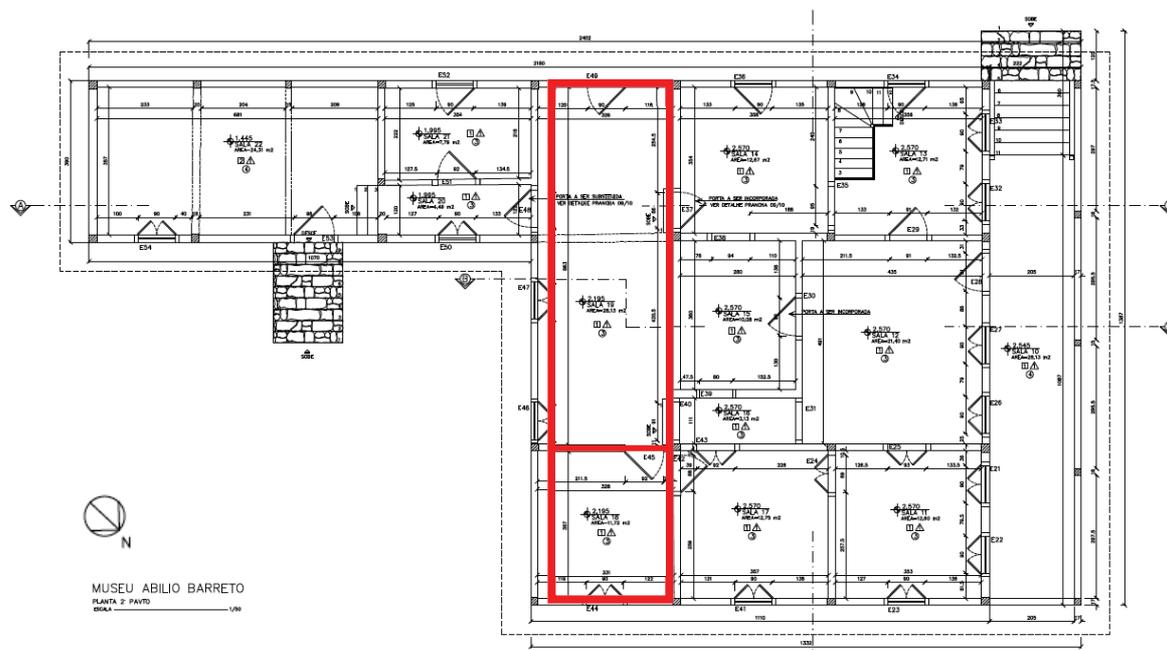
Planta do 2º Pavimento do Museu Abílio Barreto – salas pré-selecionadas para medição de iluminâncias. Fonte: Acervo do Museu Abílio Barreto
